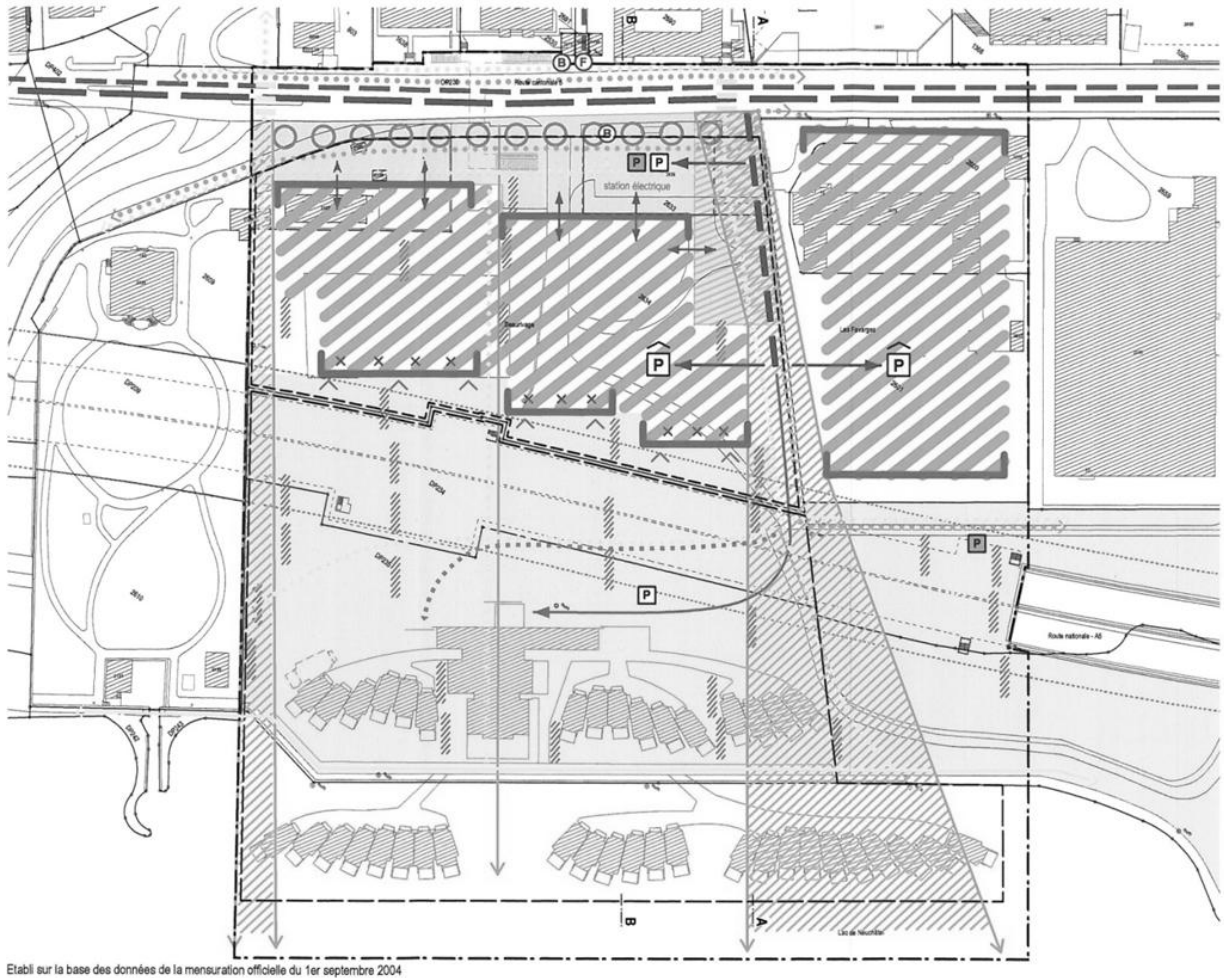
Plan directeur sectoriel Monruz sud (adoption 2010)
